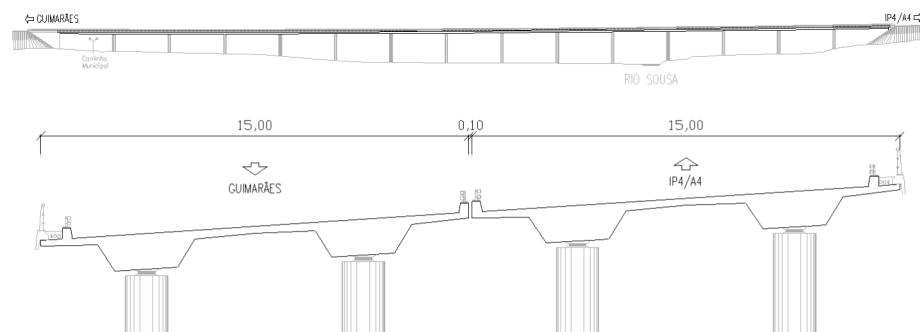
Perfil longitudinal (em cima) e secção transversal (em baixo) da ponte sobre o rio Sousa [6]
